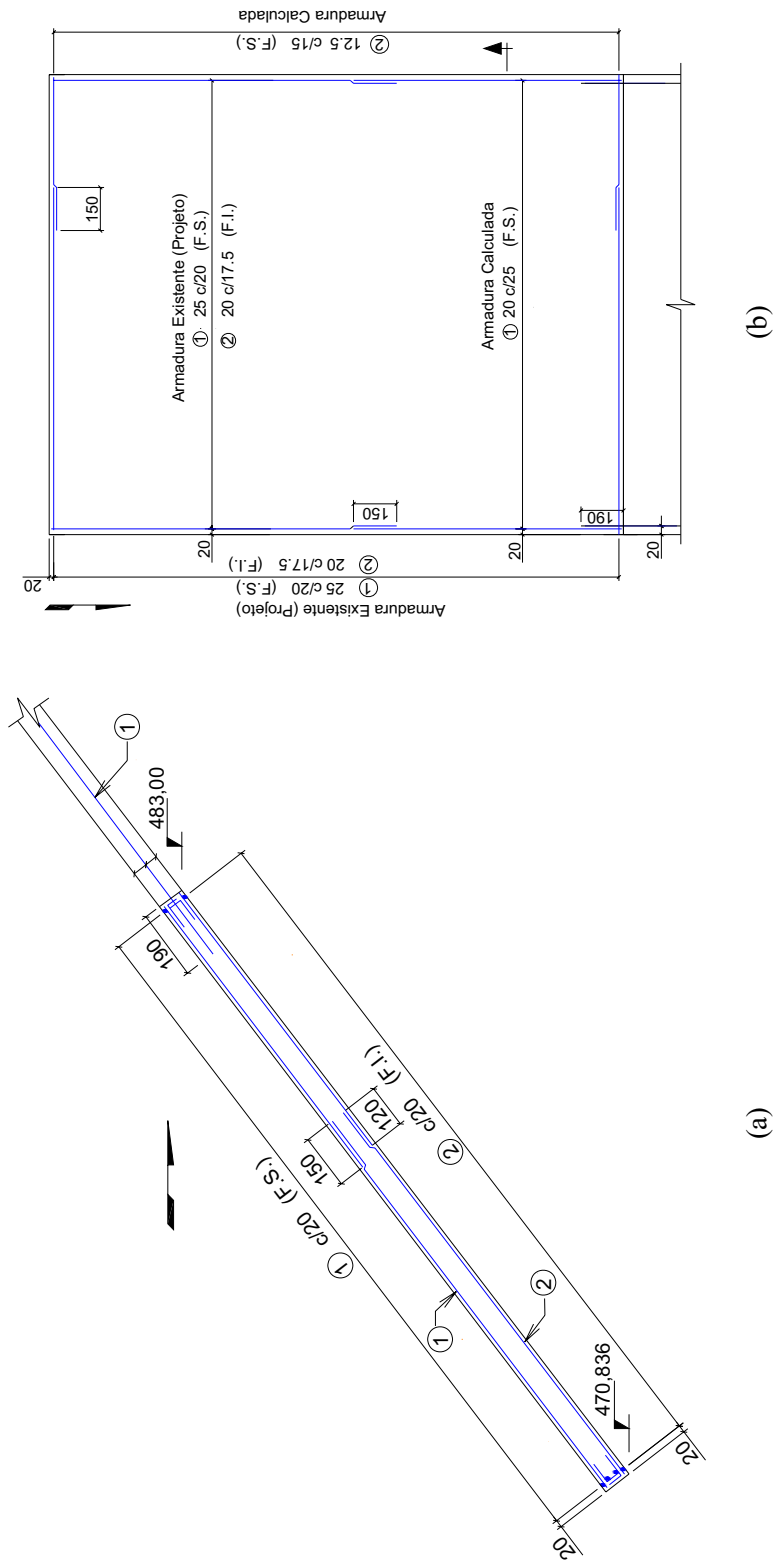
Distribuição das armaduras da laje de arranque do painel 20: (a) Seção transversal; (b) Planta.
